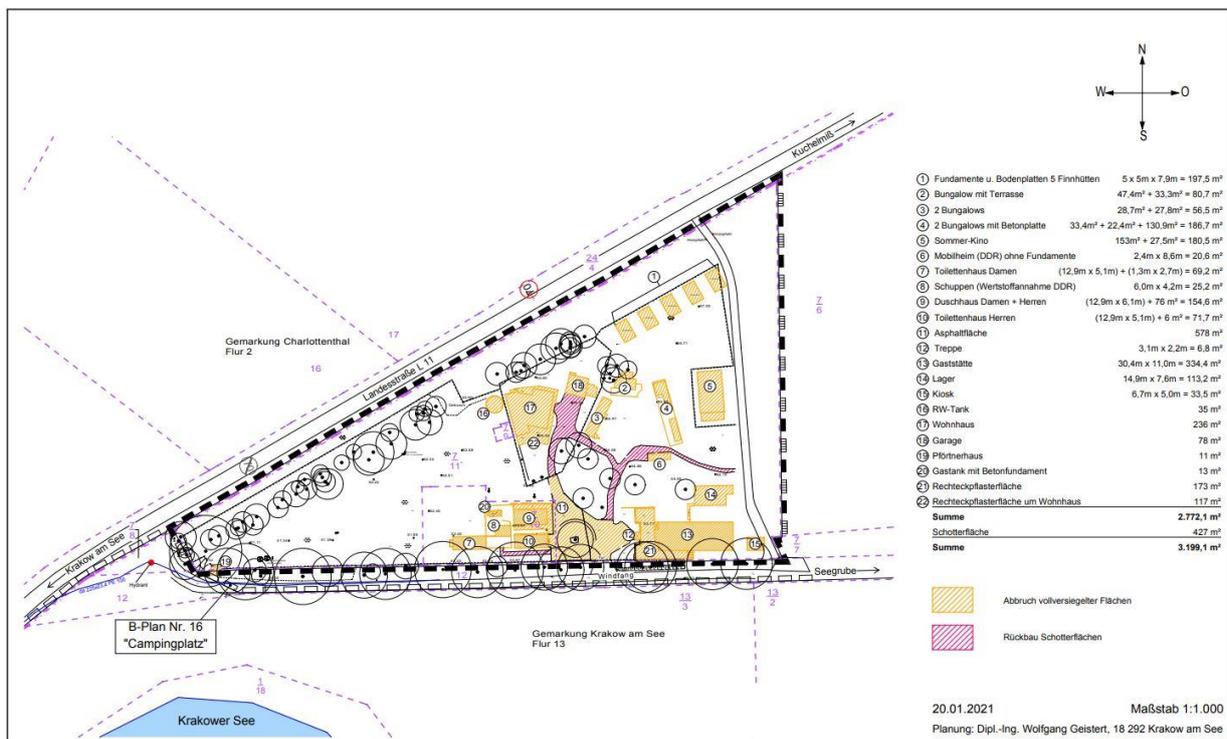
Abbruchplan im Plangebiet des B-Plans 47 „Ferienanlage am Campingplatz“
